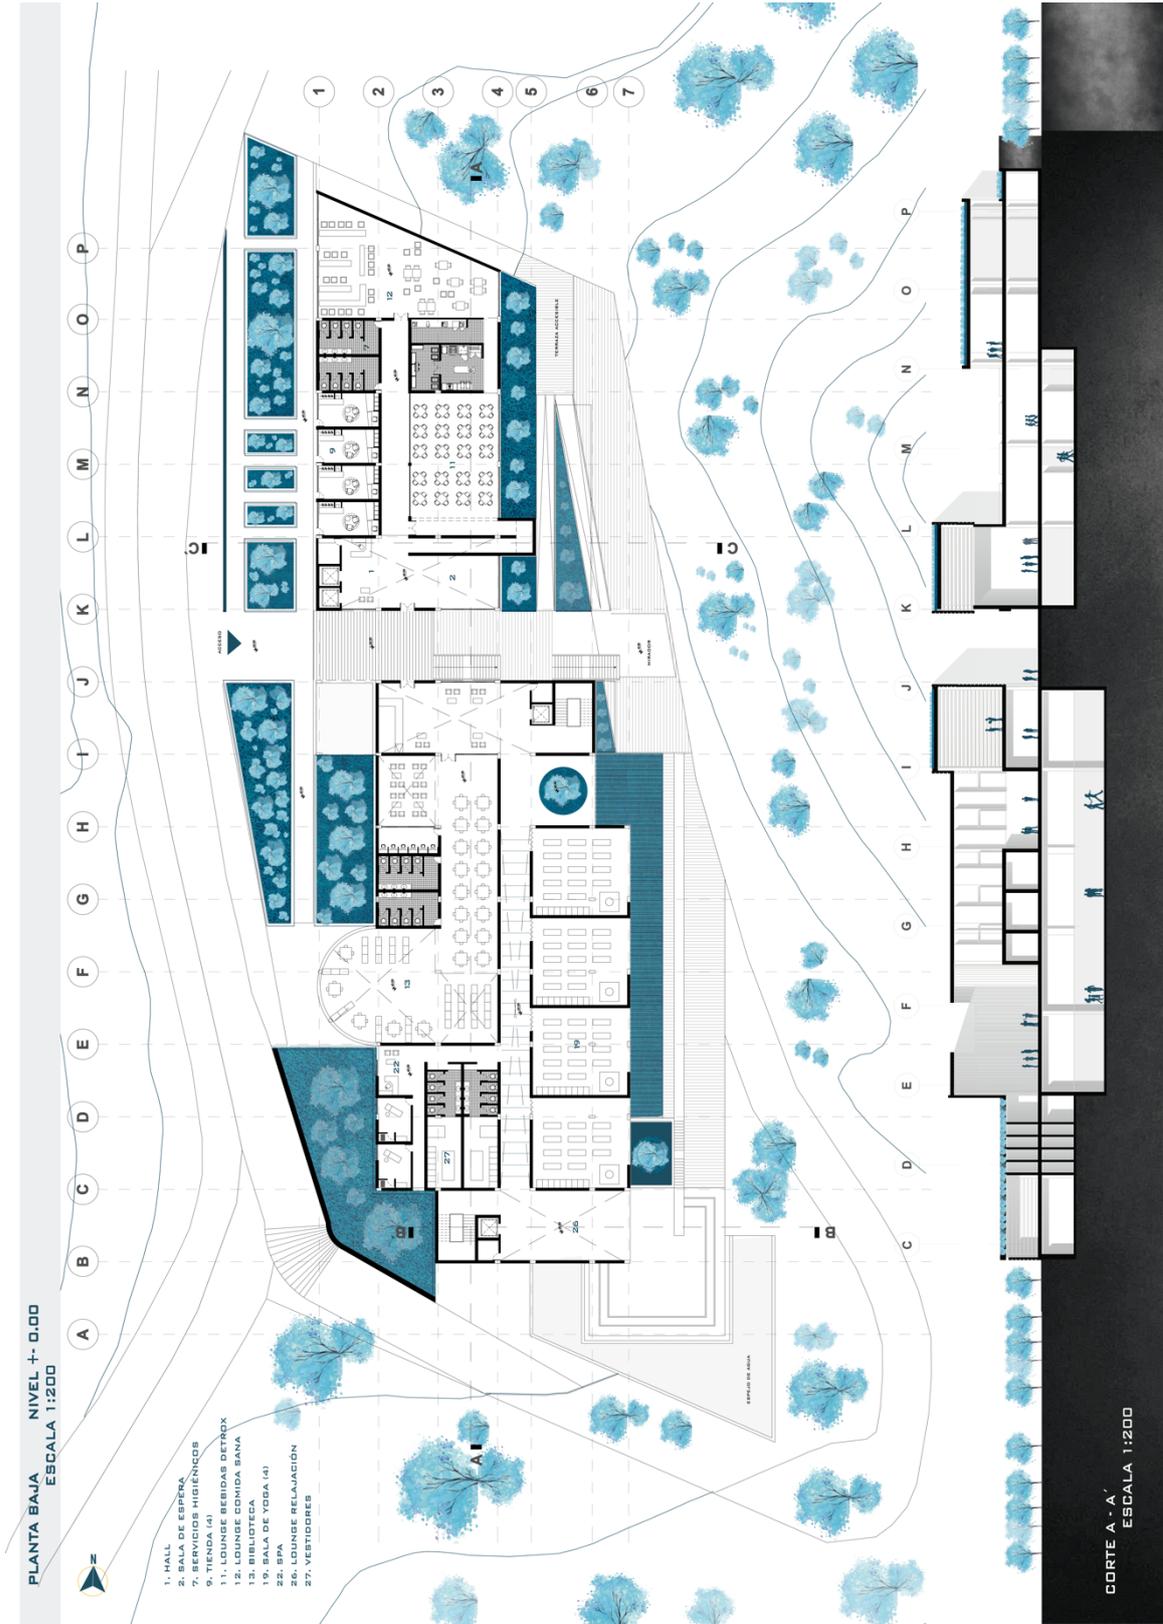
Planta Baja y Corte Longitudinal A-A'. (Elemento Propio)
